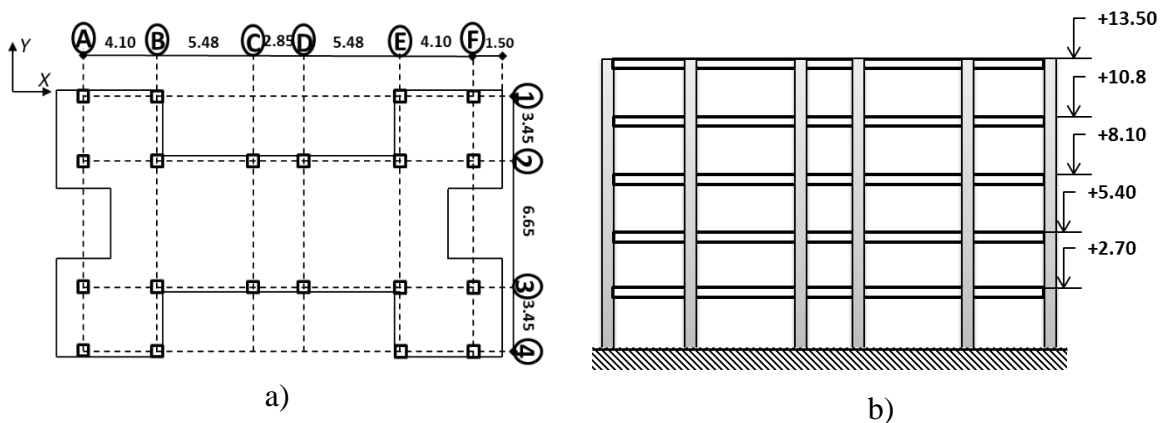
Planta y alzado de edificio de cinco niveles (dimensiones en m)
